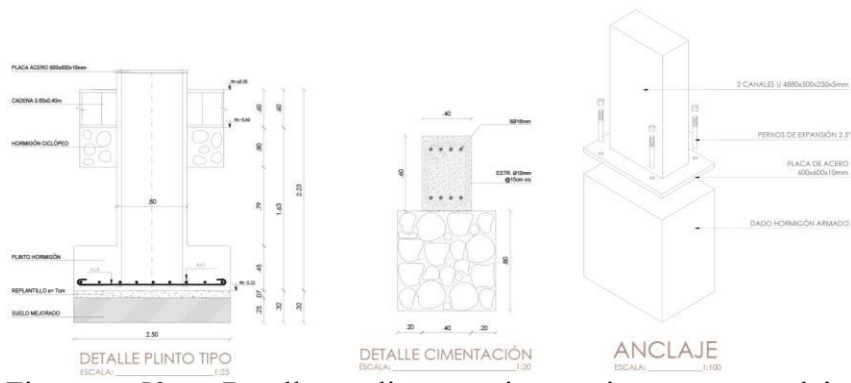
Detalle plinto, cimentación y anclaje escala gráfica 1:25
